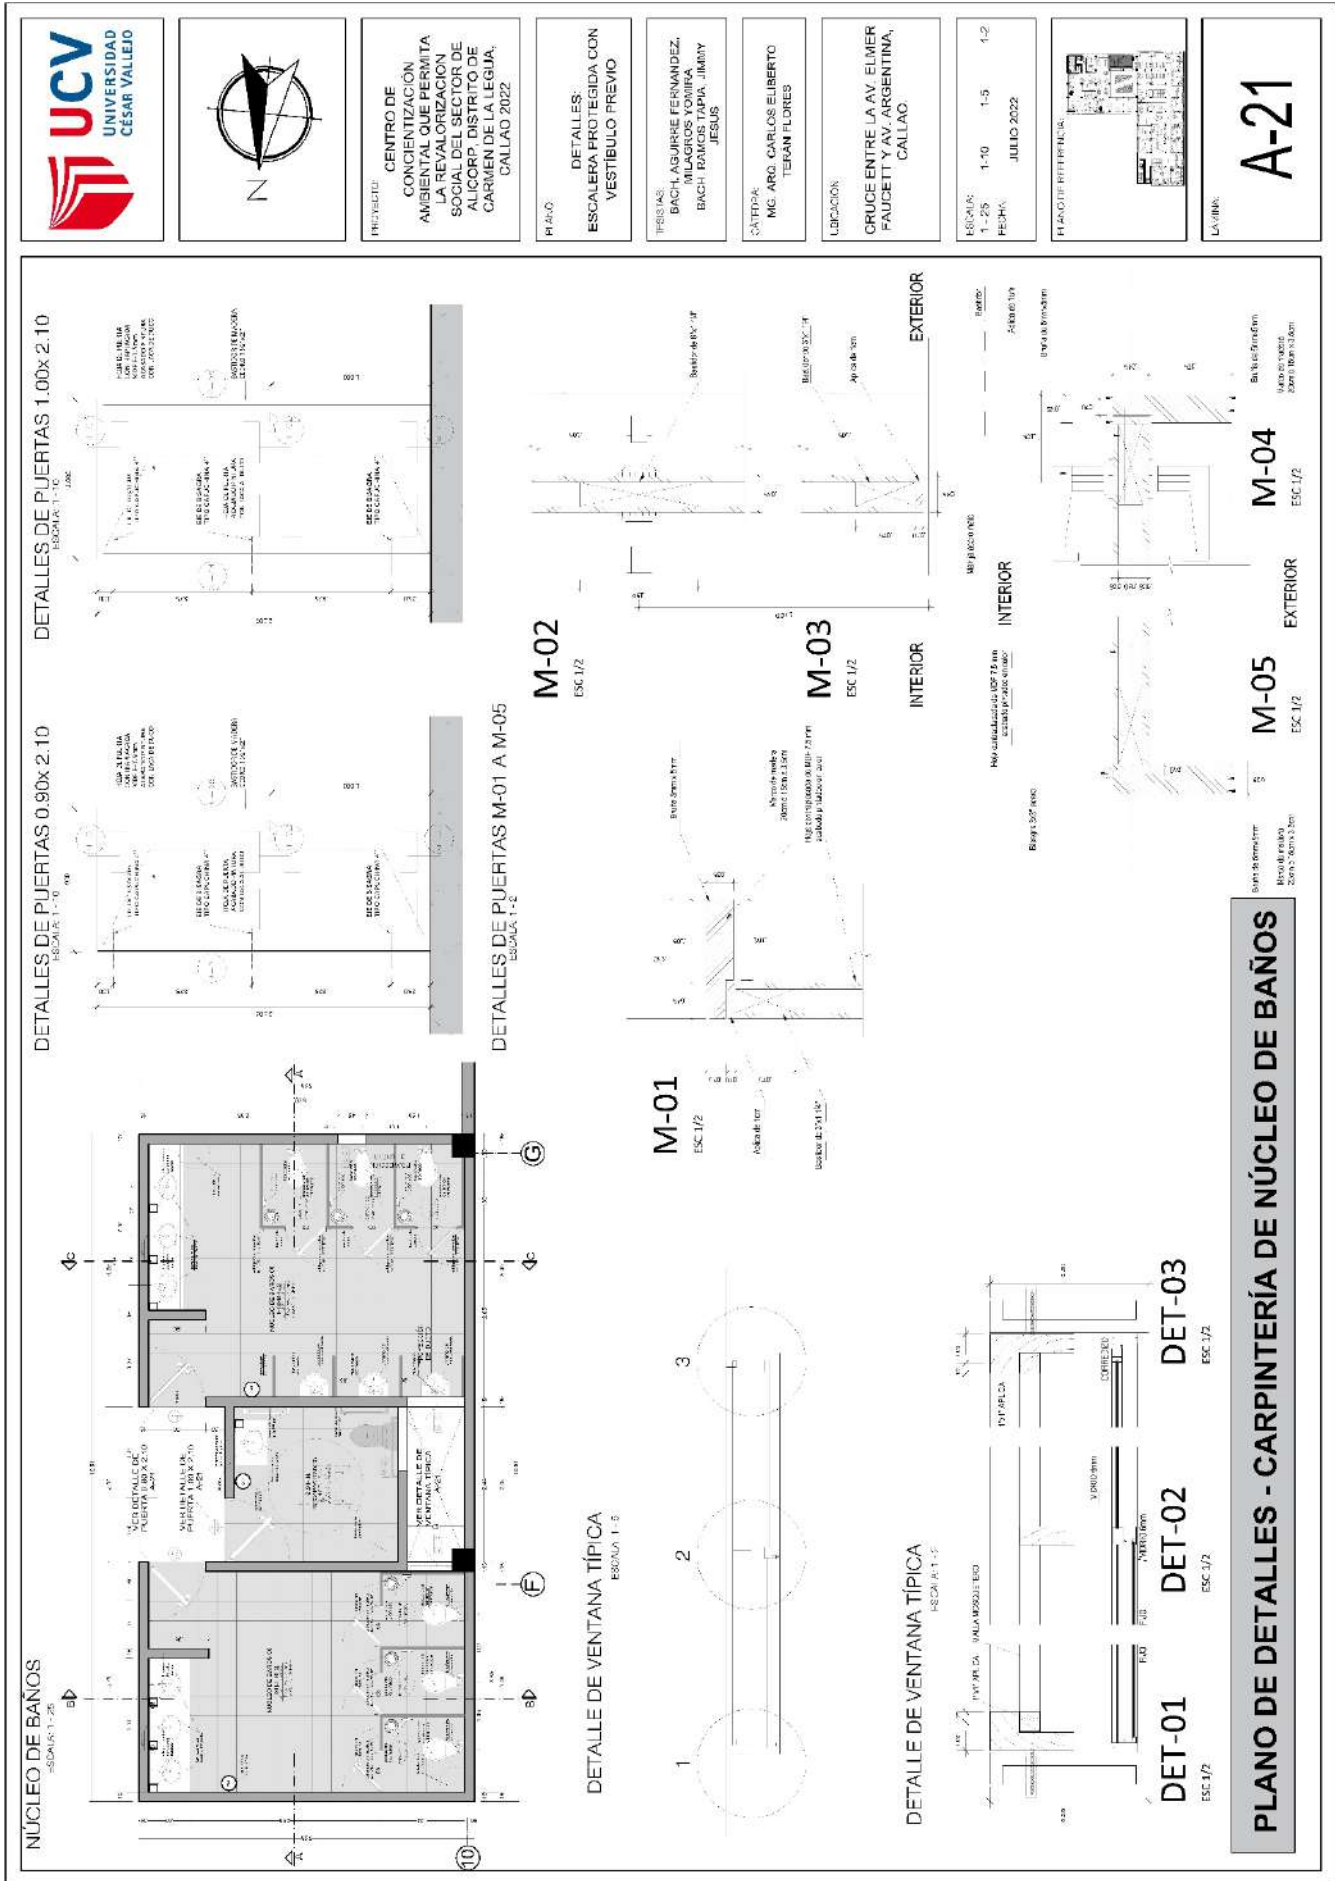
Detalles- Escalera protegida con vestíbulo previo
